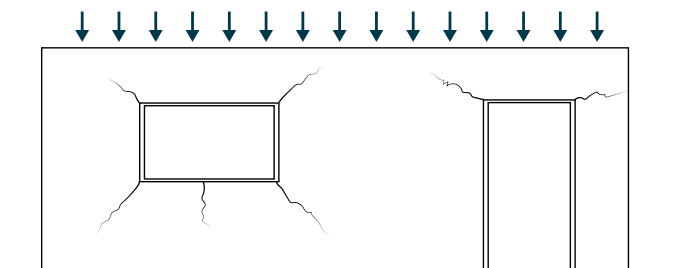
Fissuração típica em parede com presença de aberturas, devido à atuação de carga uniformemente distribuída. Fonte: <>.
